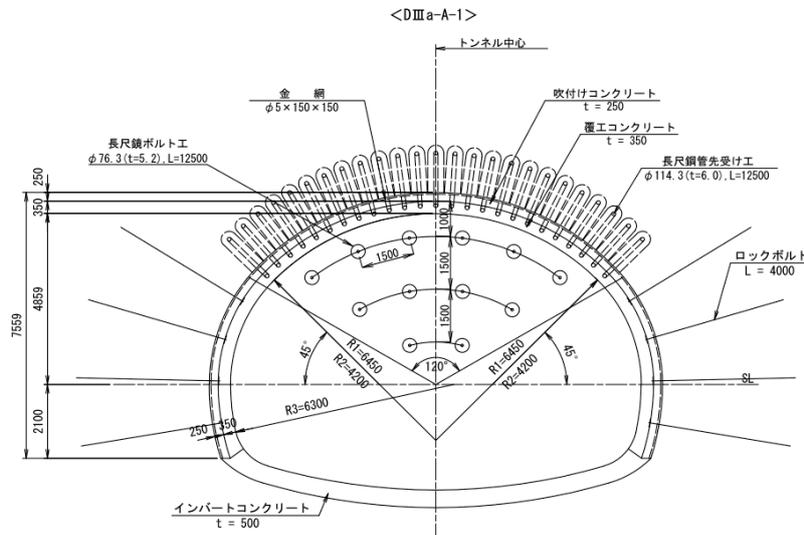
補助工法 (長尺鋼管先受工、長尺鏡ボルト工) 標準断面図
